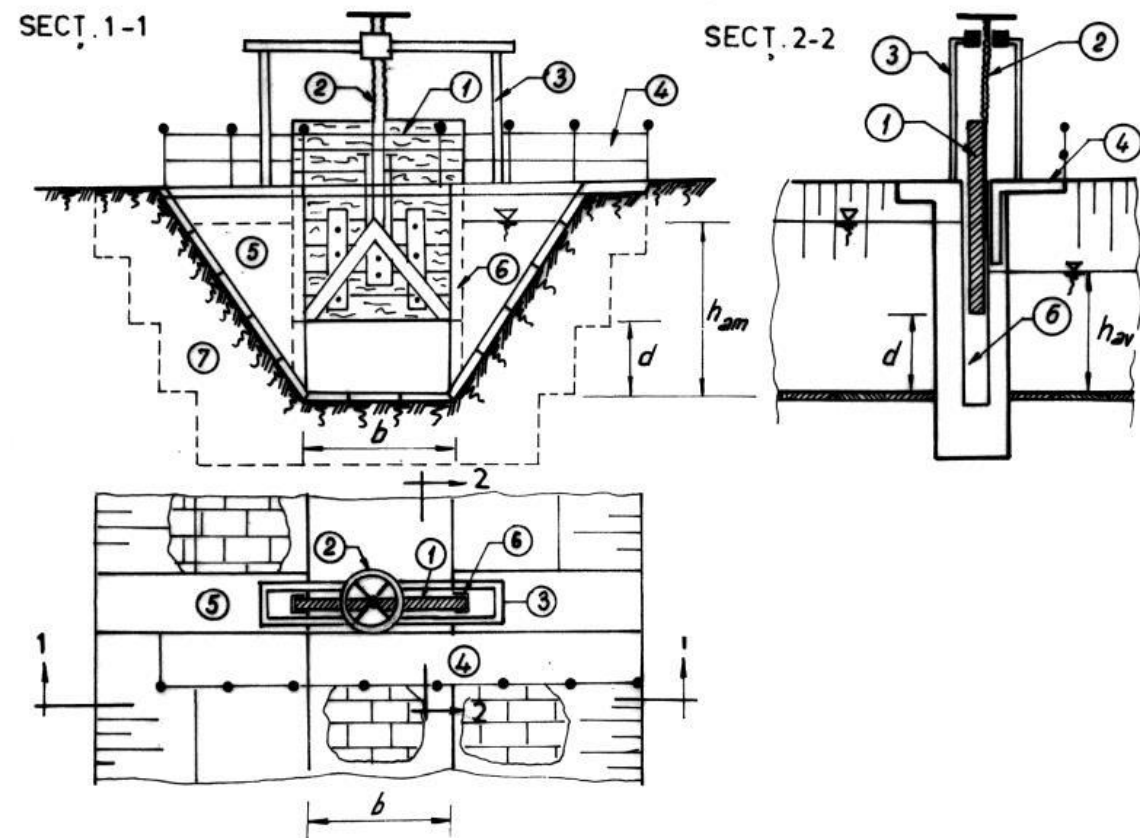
Stavilă plană verticală (cu oblon de lemn)
